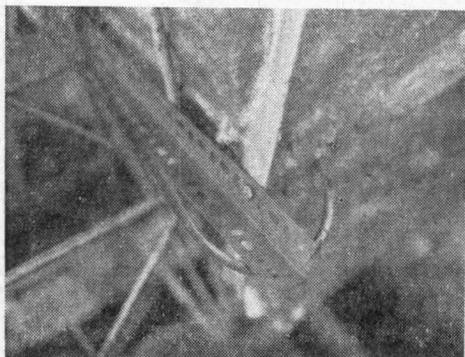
FOTO VII — Detalhe da fixação na torre, com cantoneira metálica perfurada.
